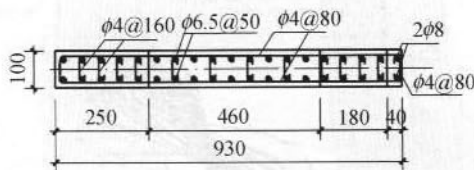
试件 3、试件 4 的截面配筋图(单位:mm)
